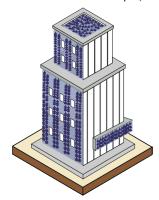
Infraestructura Verde Artificial ( Fachada y Cubierta) Fuente: Elaboración Propia, 2023
